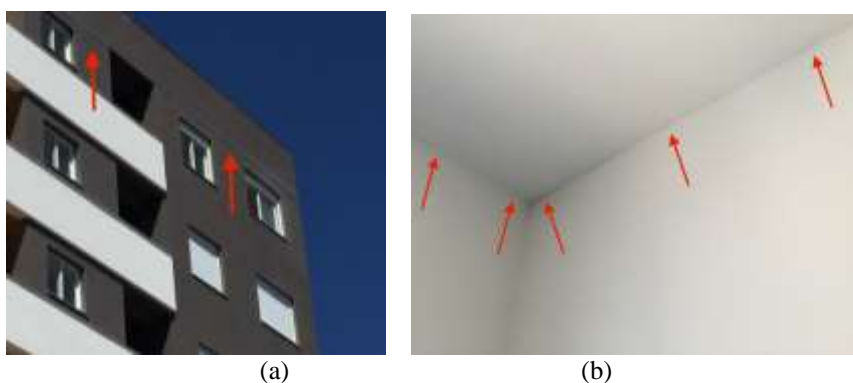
Empreendimento 2-D: vista externa de fissuras horizontais junto a laje do último pavimento (a); vista interna de fissuras horizontais junto a laje do último pavimento (b).
